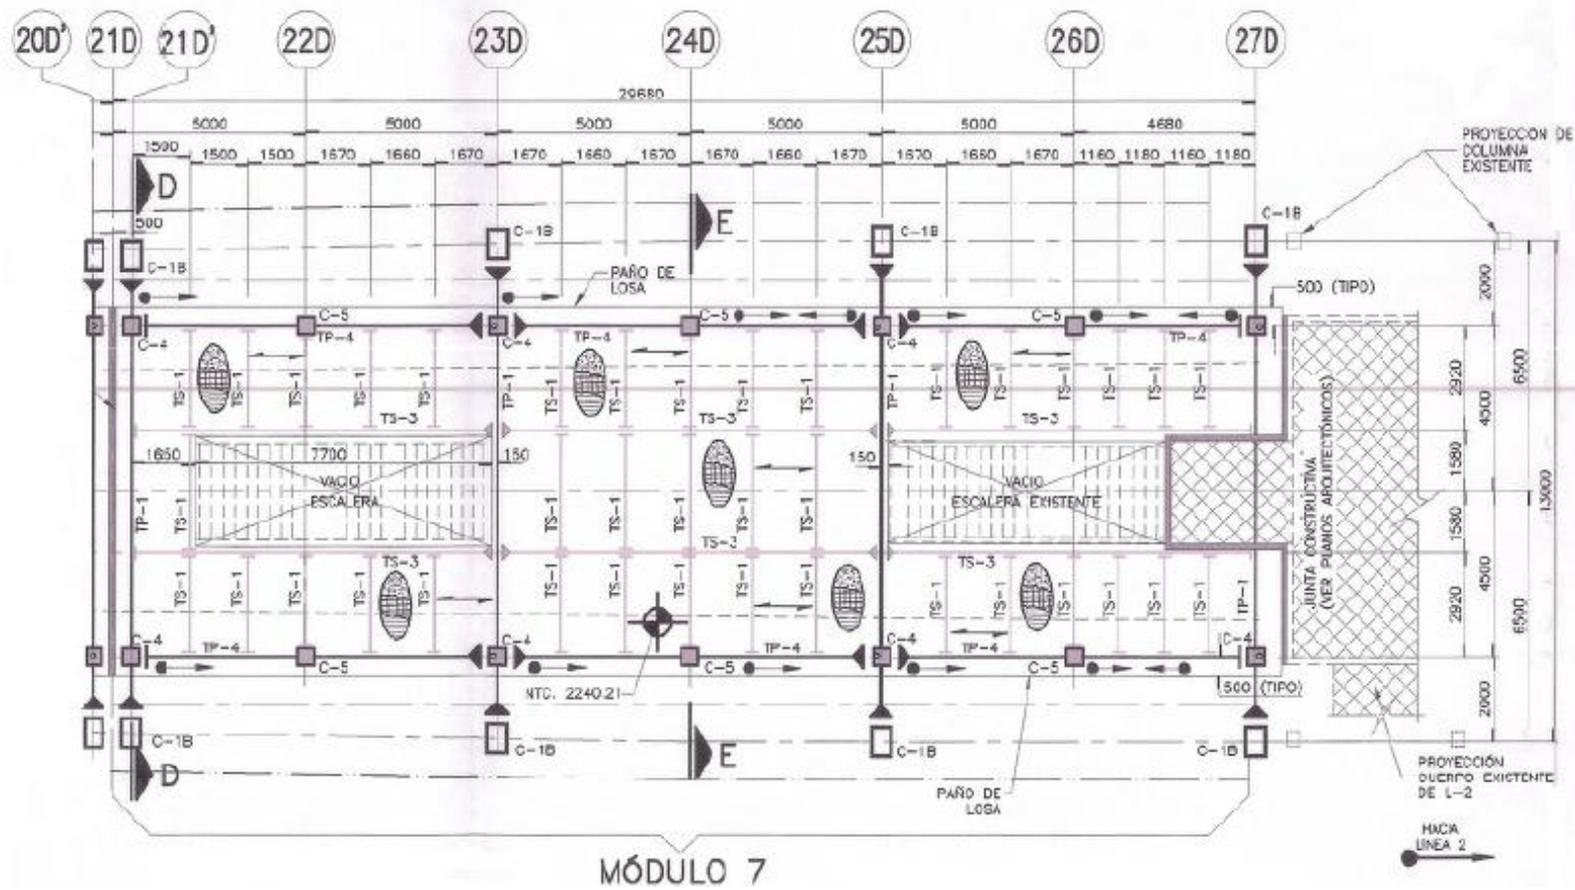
Planta de estructuración nivel pasarela, módulo 7.
